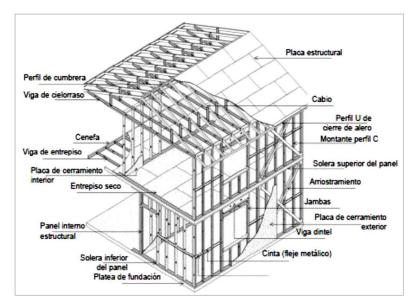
Esquema de Vivienda con el sistema "Steel frame"
